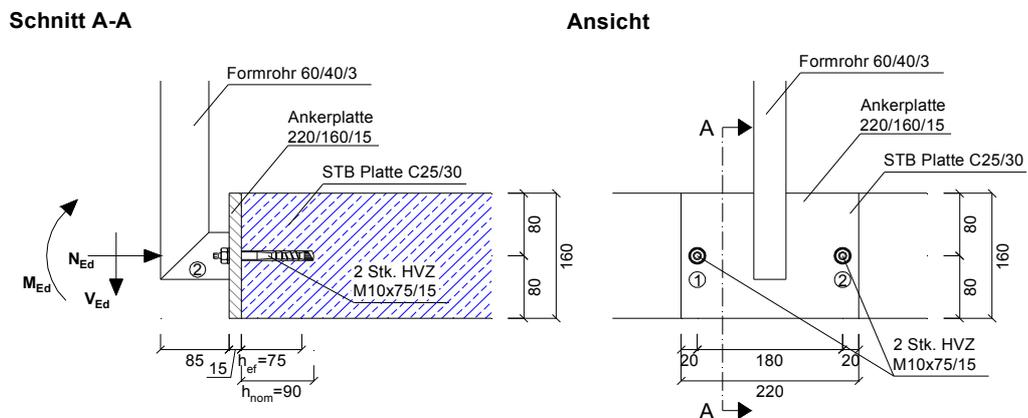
Anschlussdetail G2 Dübel Variante 2 (Maße in mm)
